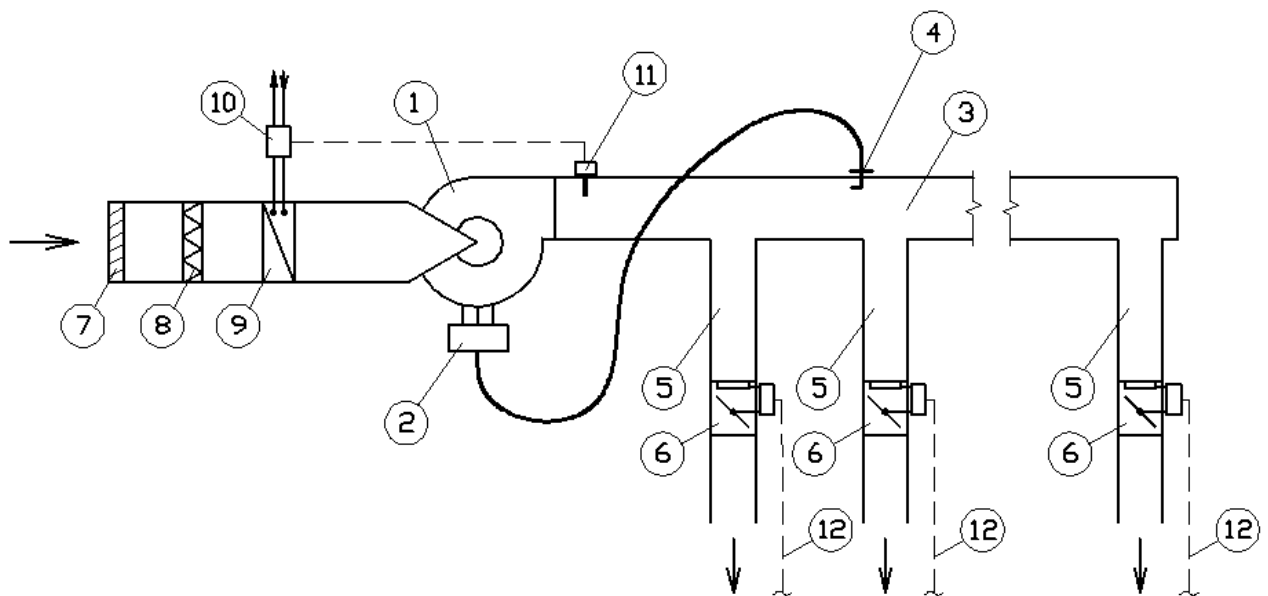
Система вентиляции, подающая только наружный воздух с изменяемым расходом (система-VAV)
